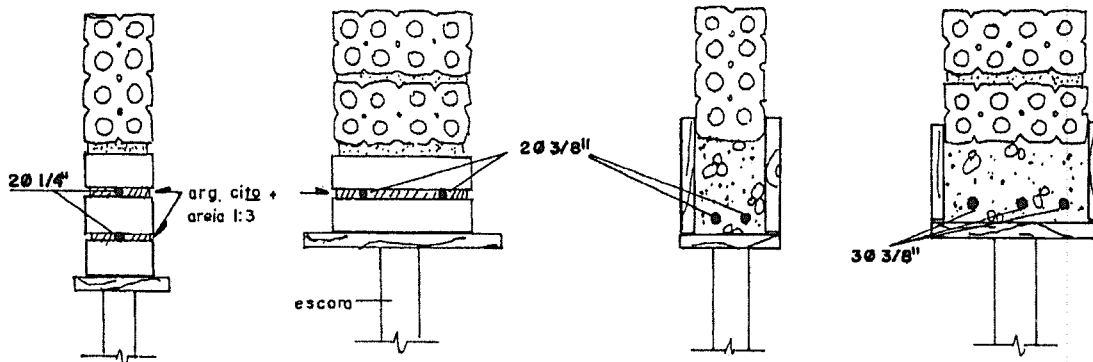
Vergas em alvenaria de tijolo furado para vãos até 1,00m e entre 1,00m e 2,00m.
